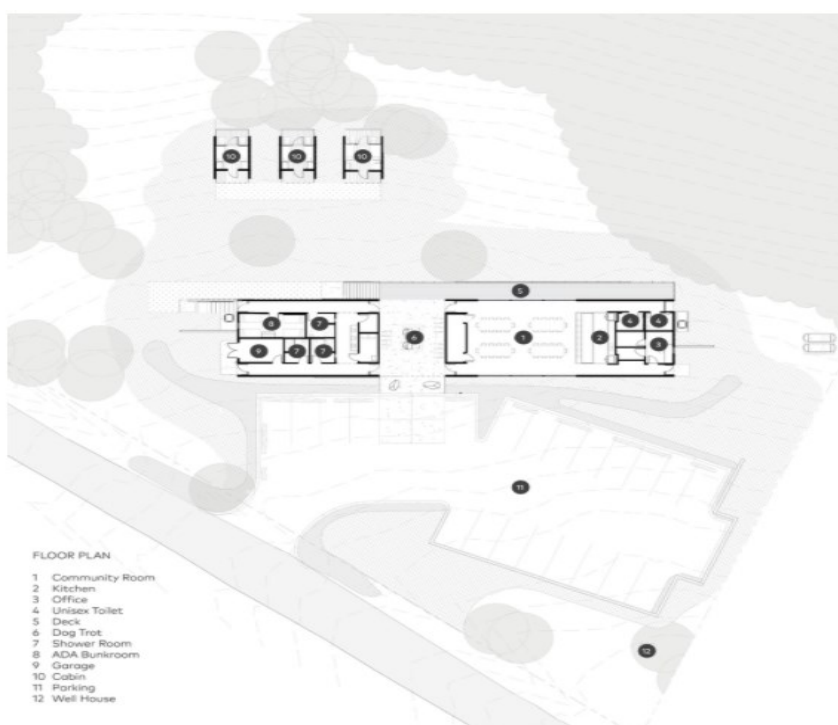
Planta arquitectónica del centro educativo Ozarks. (Archdaily, 2020).
